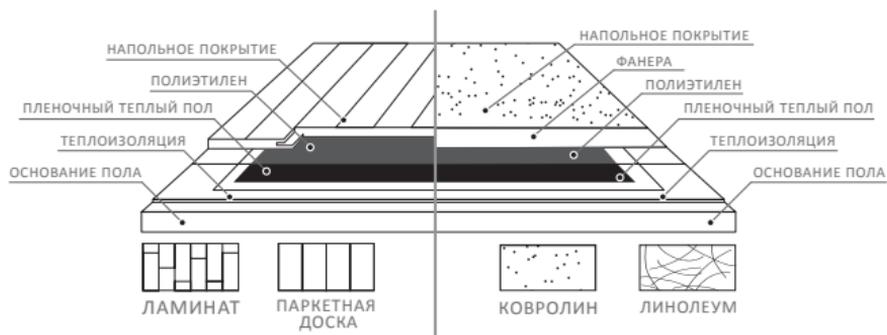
Схемы укладки твердых и мягких напольных покрытий.
